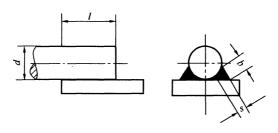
钢筋与钢板搭接焊接头 l-搭接长度;d-钢筋直径;b-焊缝宽度;s-焊缝厚度
